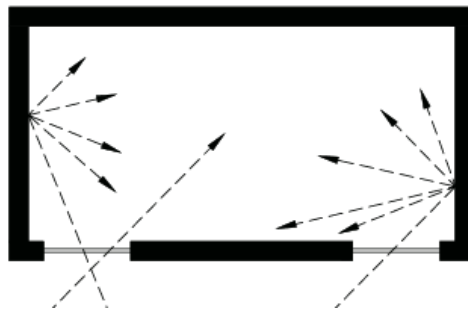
Pemasangan Jendela Terpusat dan Tersebar
